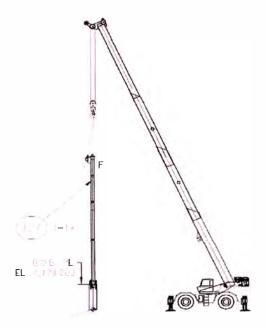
Posición de equipos para maniobra de montaje de la cepa B19
